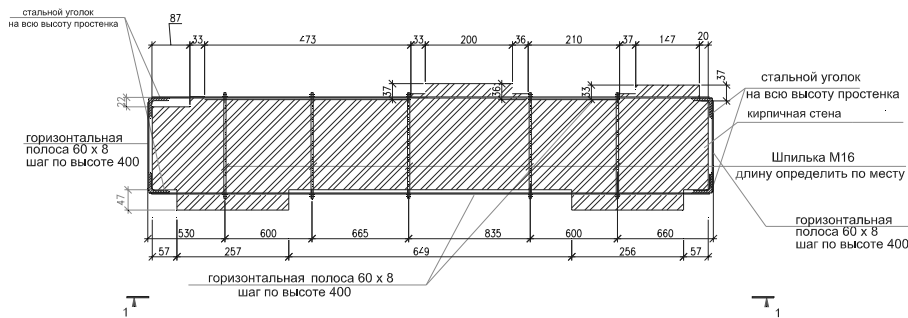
Фрагмент плана усиливаемых простенков. Стальная обойма усиления
